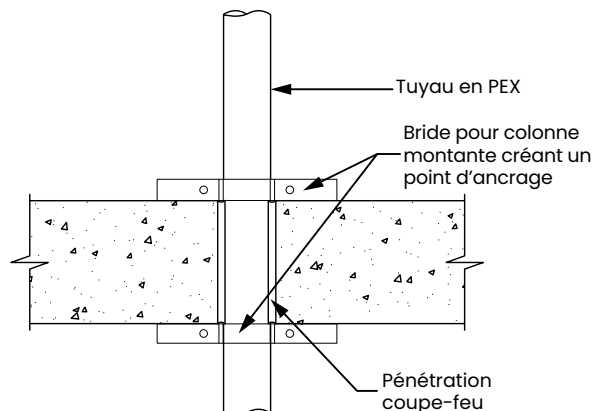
Exemple de point d'ancrage 2 (tuyauterie verticale)
